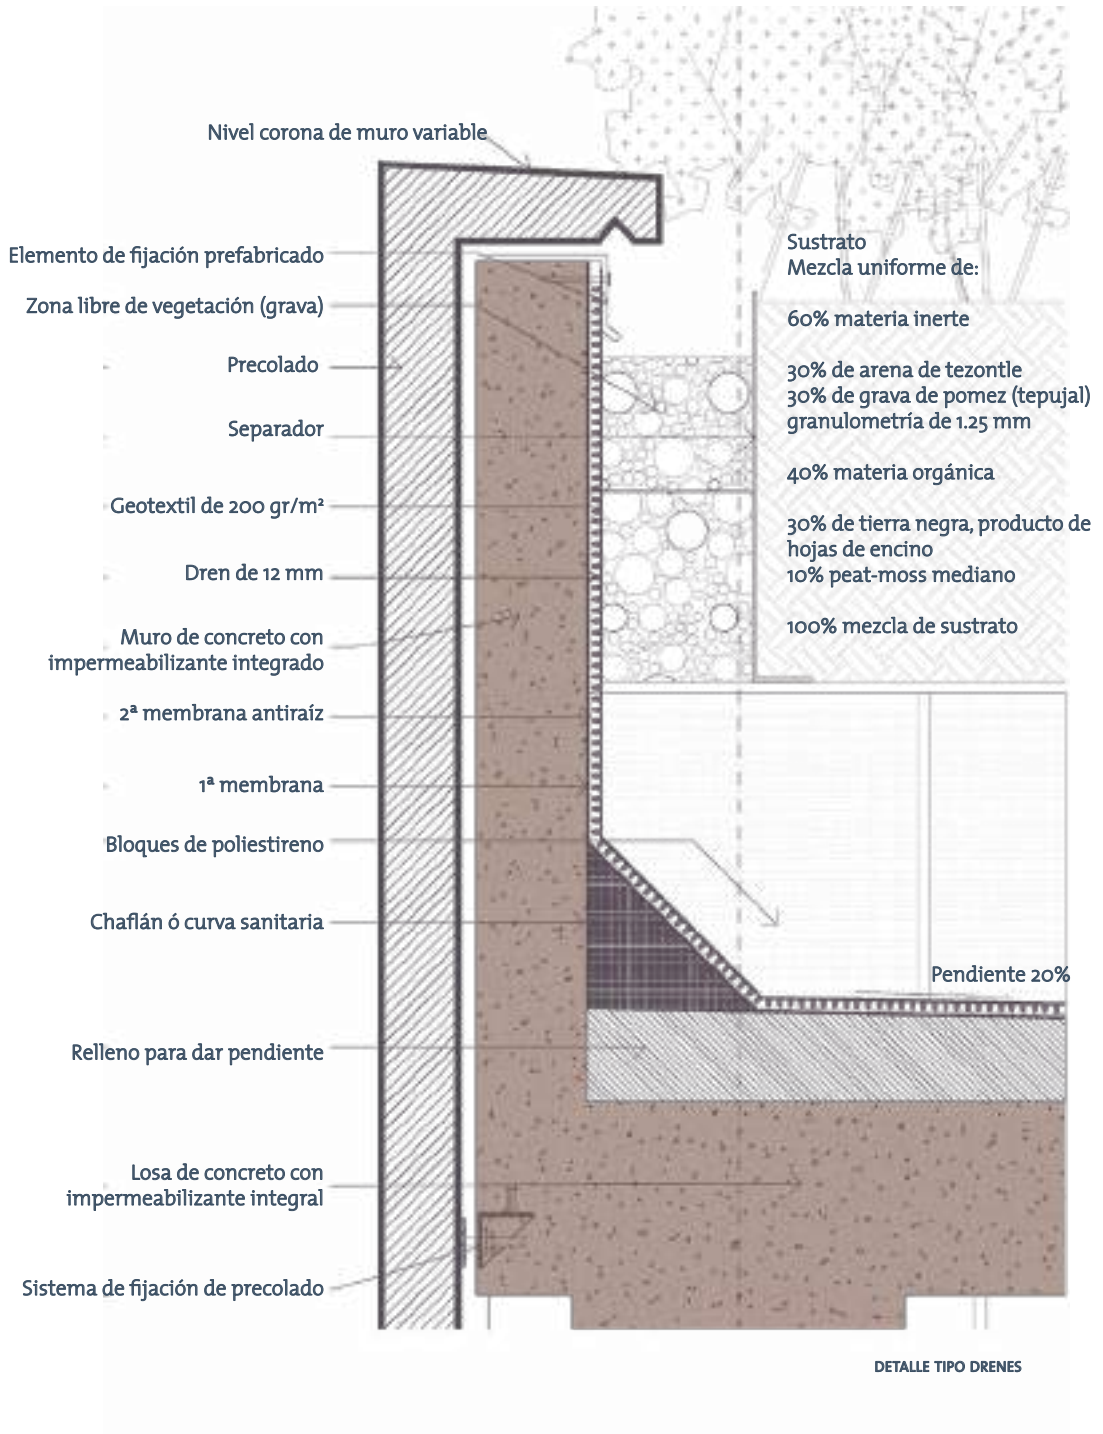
Detalles de jardineras sobre estructura, conjunto Miyana, Polanco, Ciudad de México
